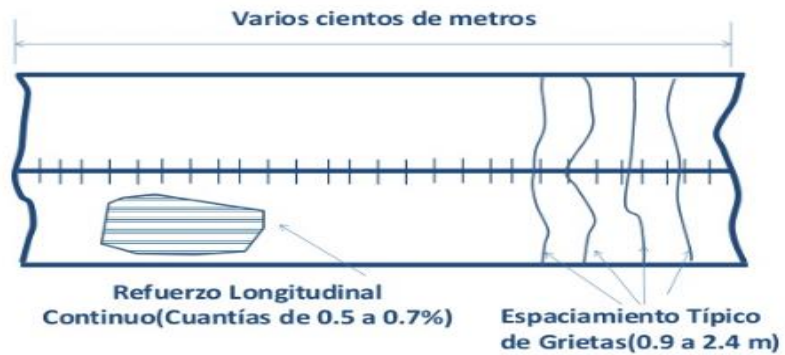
PAVIMENTO DE CONCRETO HIDRÁULICO CON REFUERZO CONTINUÓ.
